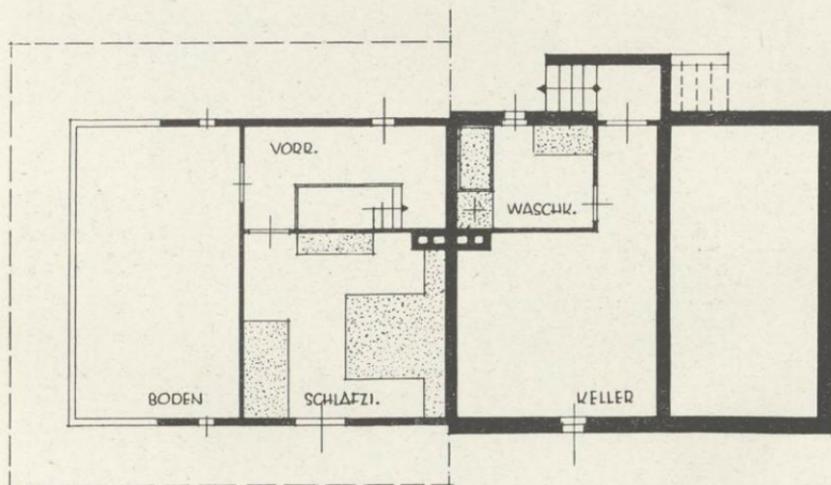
Raumausteilung (Grundriß) des Siedlungshauses St. Peter-Linz Type A
